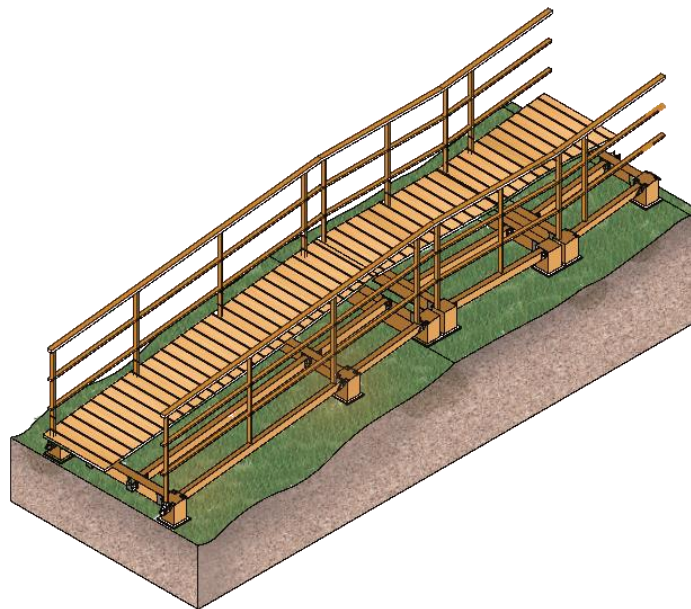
Detalle estructural rampa en madera. Elaboración propia.
